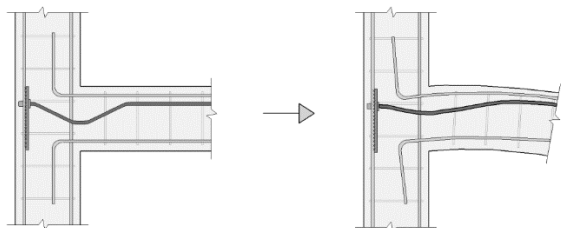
Работа узла рамного железобетонного каркаса с дополнительным армированием
